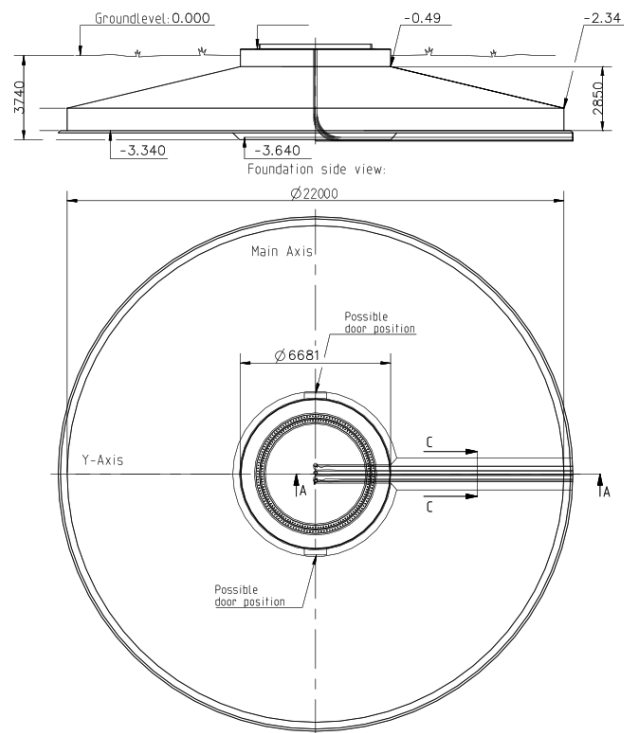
Cimentación propuesta, pendiente de verificar tras estudio geotécnico
